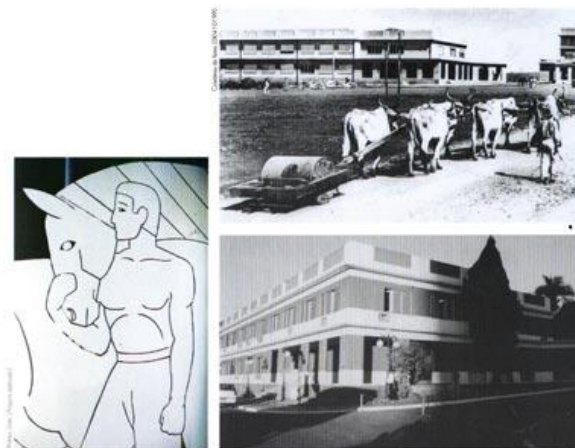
Detalhes, construção e fachada da construção. Livro Goiânia art déco.
